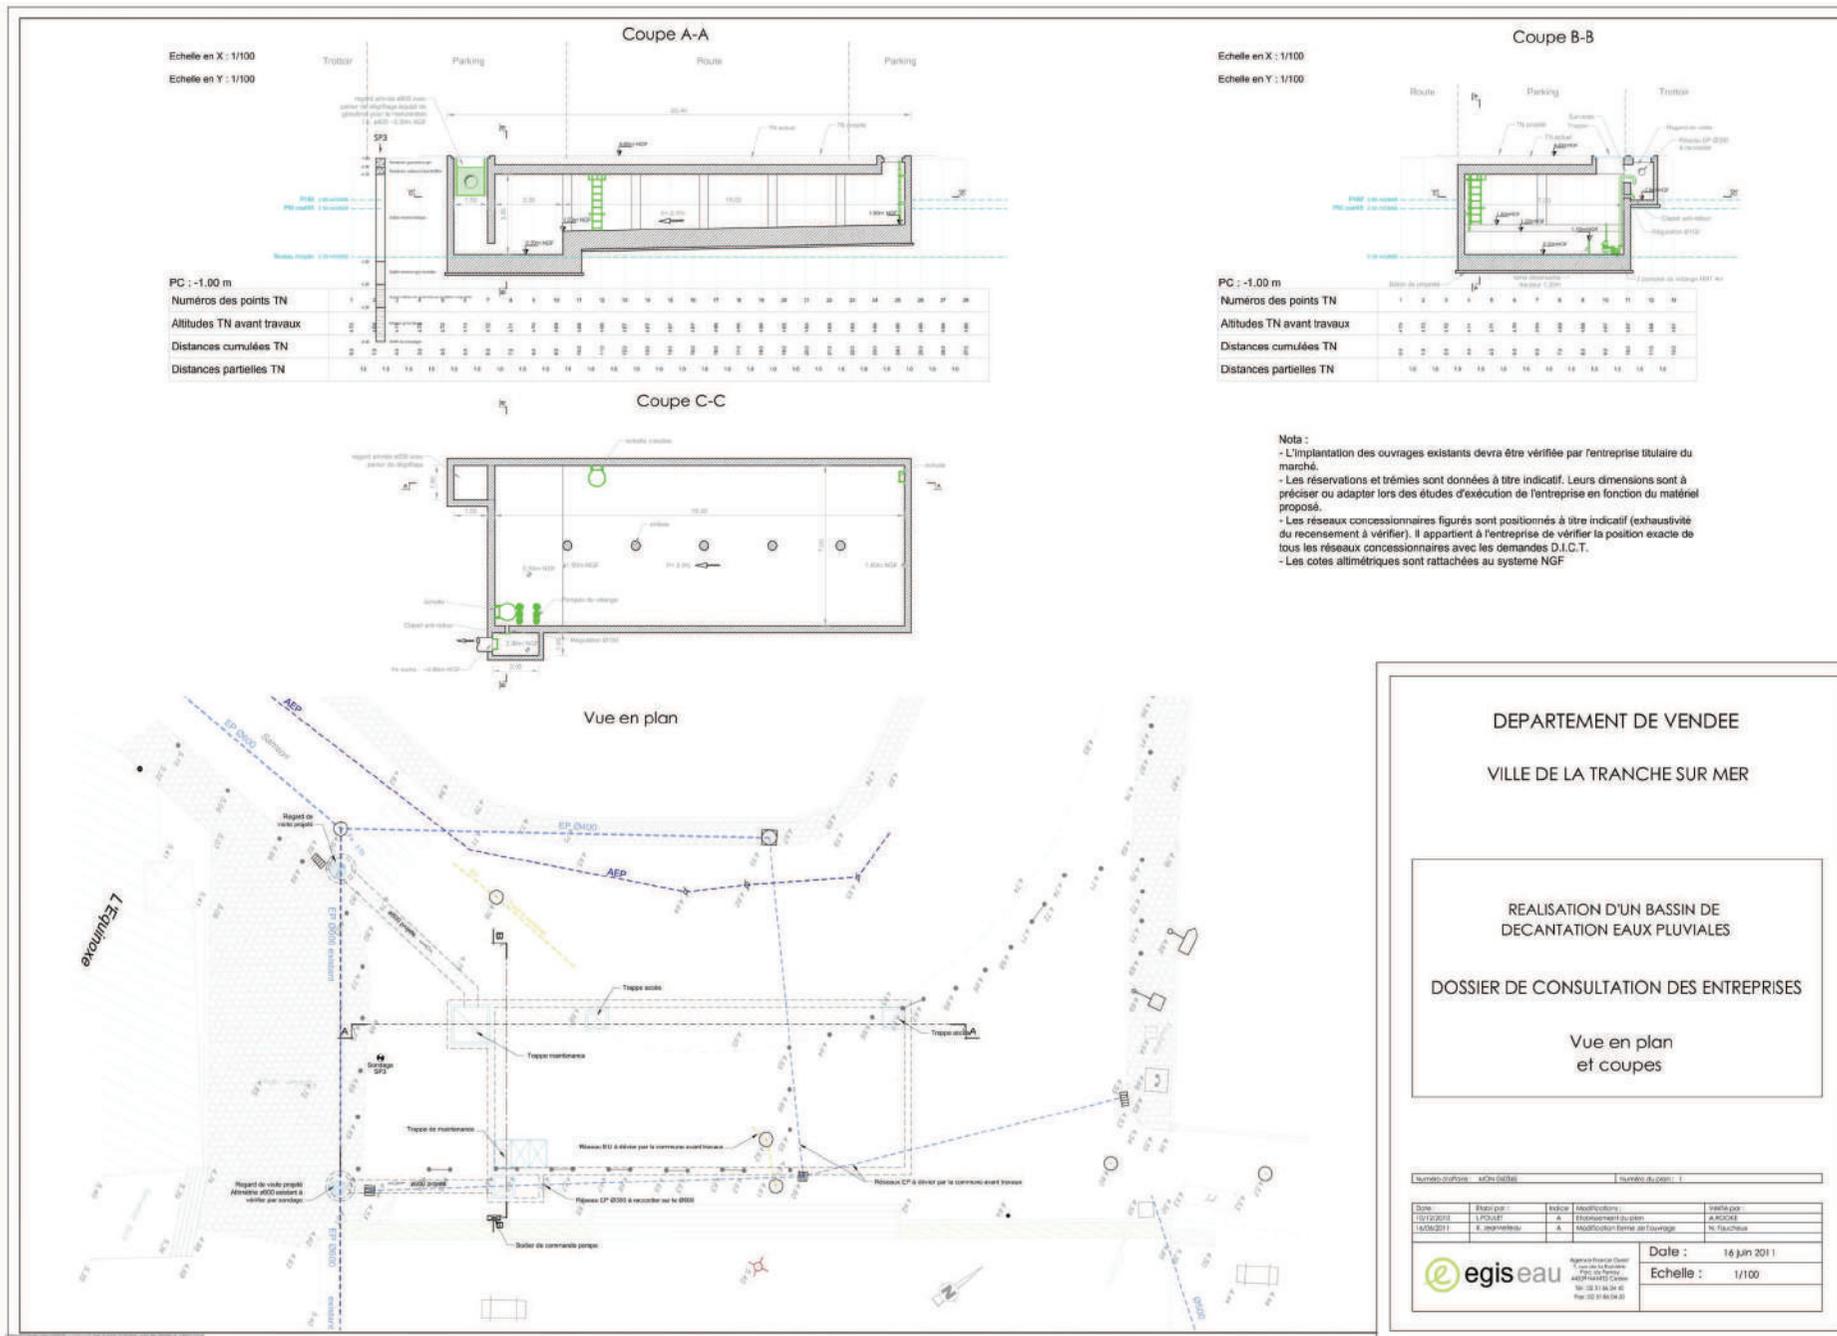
Plan du bassin de décontation des eaux pluviales du Belvédère
